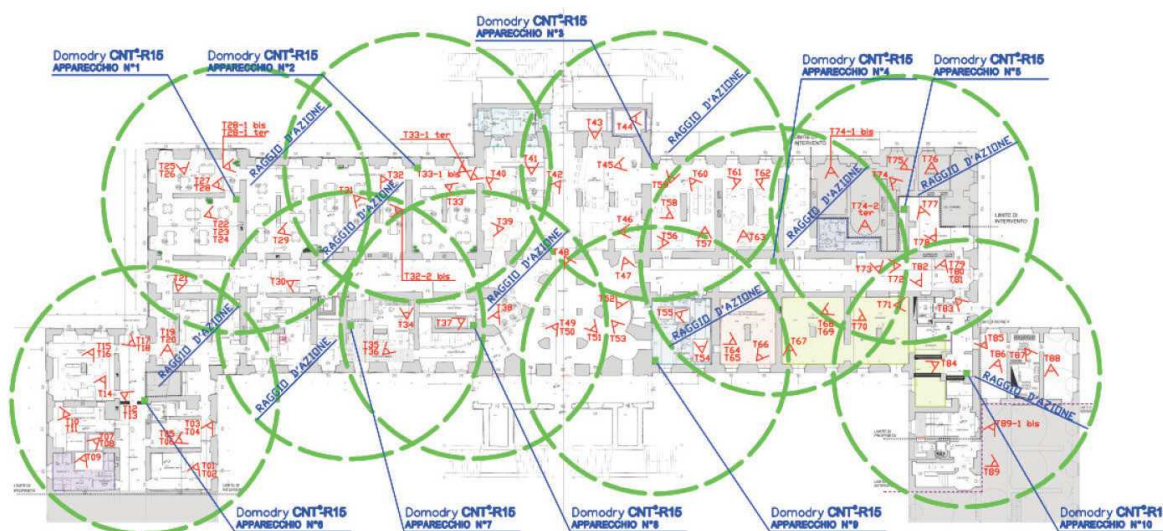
Villa Reale di Monza: schema planimetrico impianto CNT
